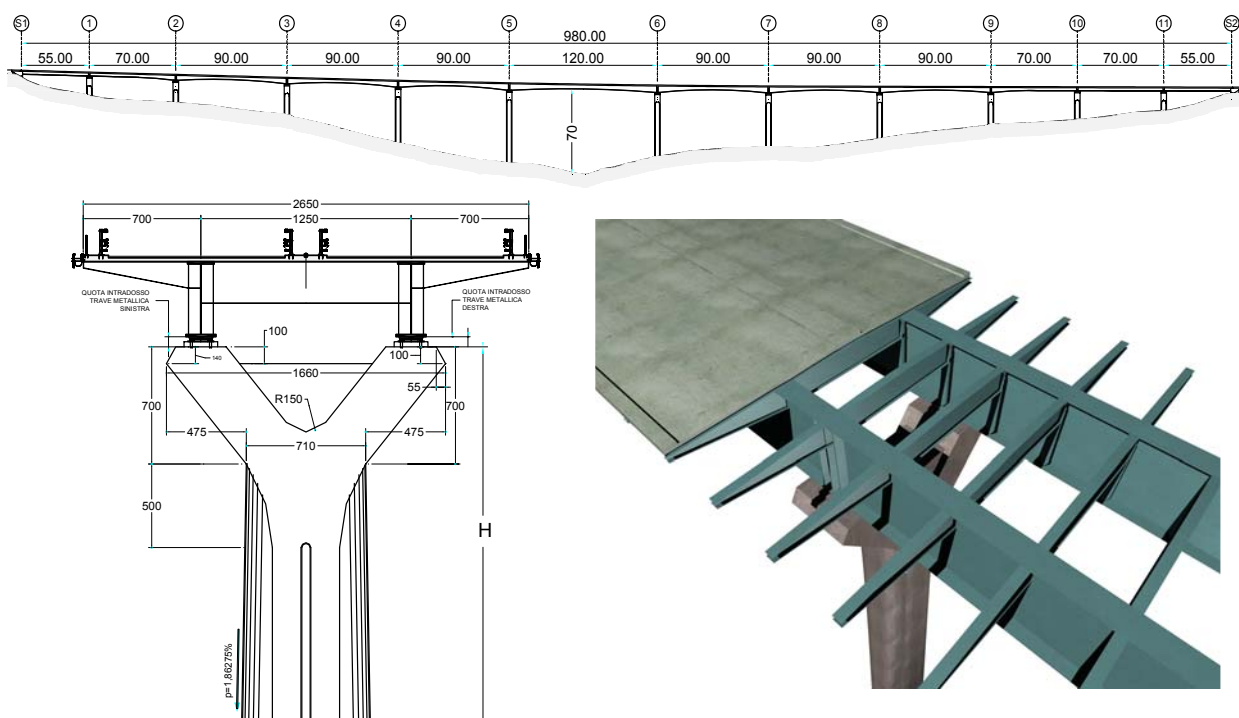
Viadotto Serra Cazzola: vista longitudinale, sezione
